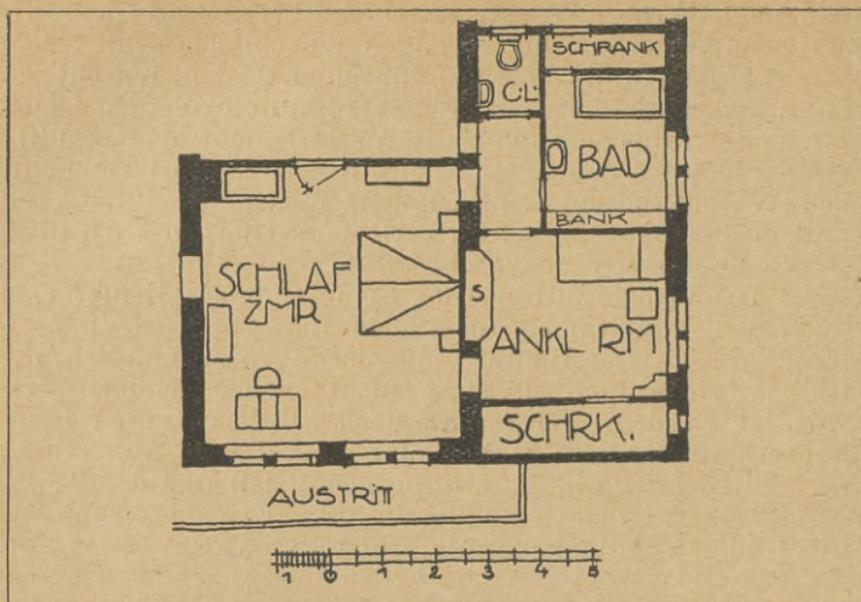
Schlafzimmer mit Ankleideraum und Bad
